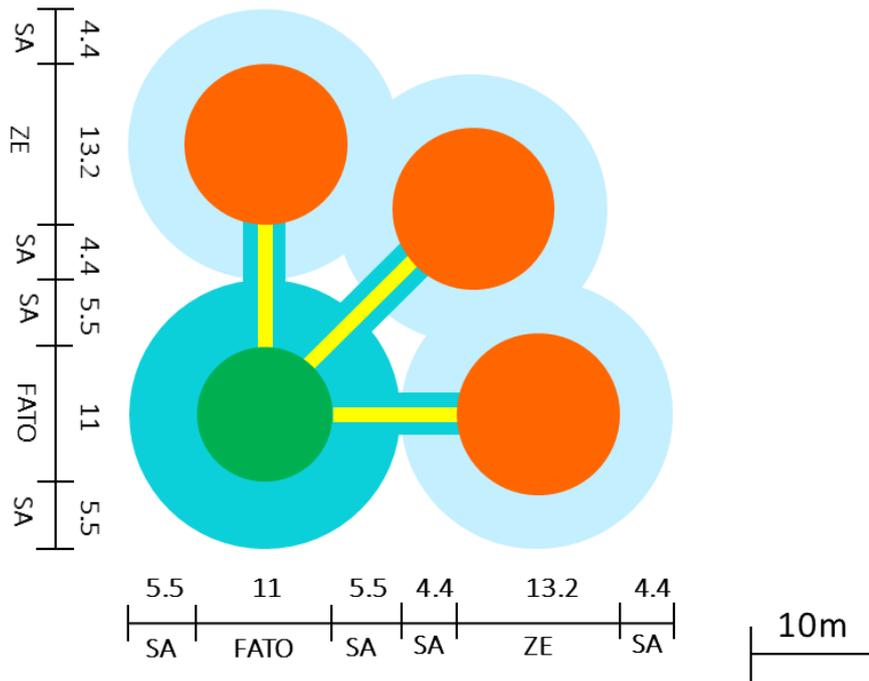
Plano dimensionado de la pista en configuración semi-estrella. Fuente: elaboración propia, 2019
